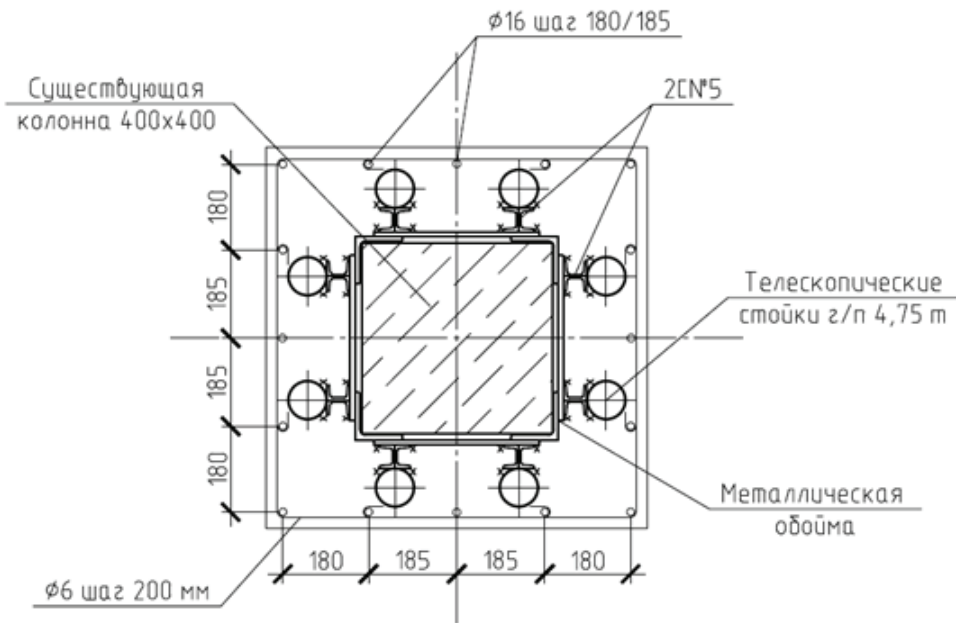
Горизонтальный разрез колонны с установленными стойками и армированием
